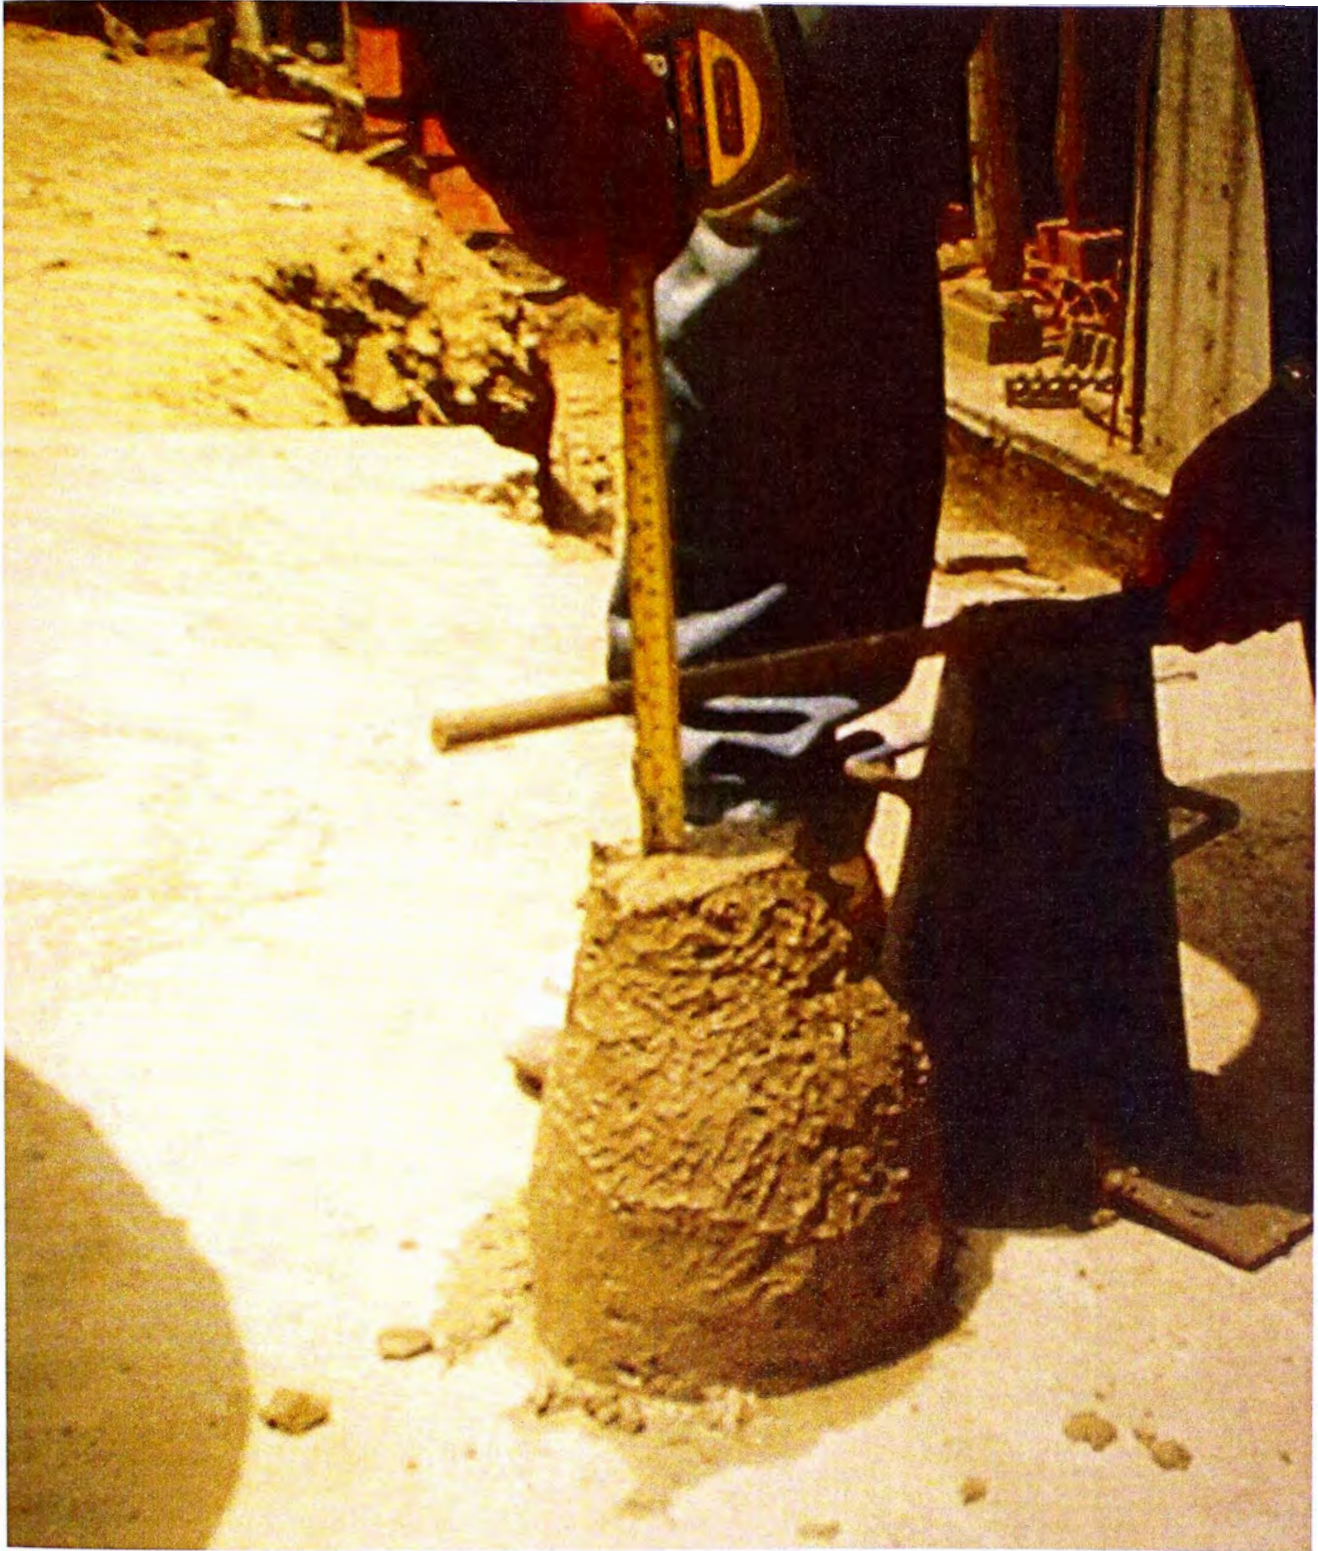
VISTA DE PRUEBA DE MEDICION DEL SLUMP DEL CONCRETO
